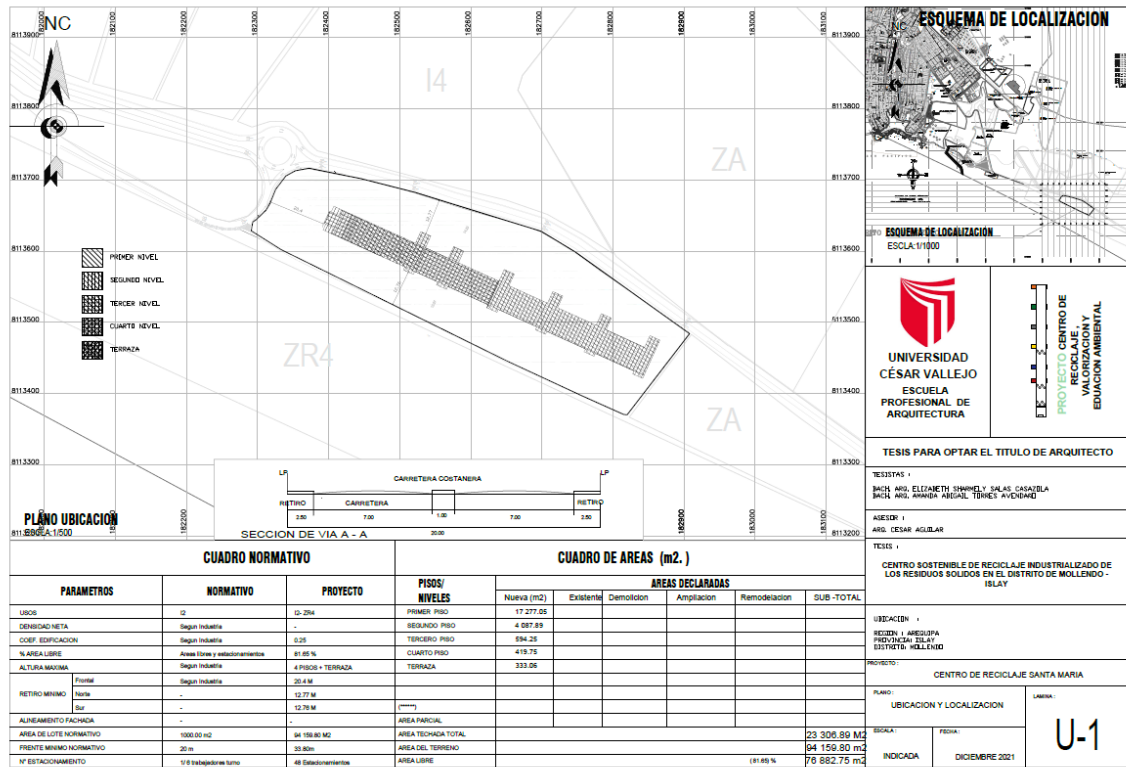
Plano de Ubicación de Proyecto. FUENTE: Elaboración Propia
